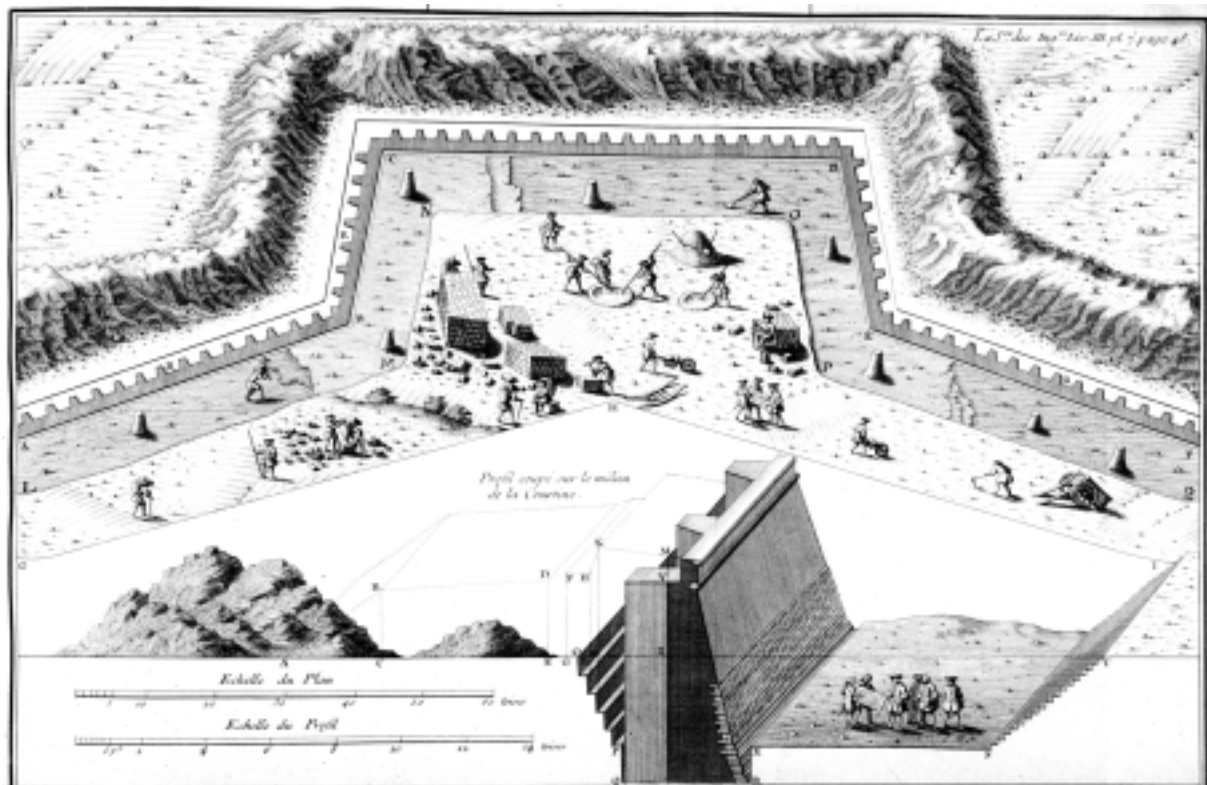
Belidor M.D.CC.XXII. (1722). Buch 3. Plan 8.
